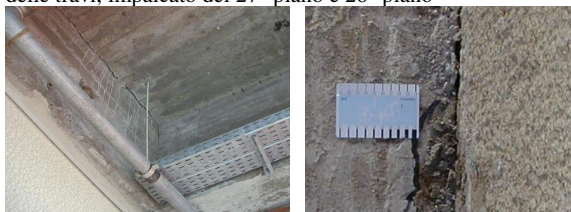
Impalcato del 26° piano: Fessura all'incastro delle travi di estradosso
